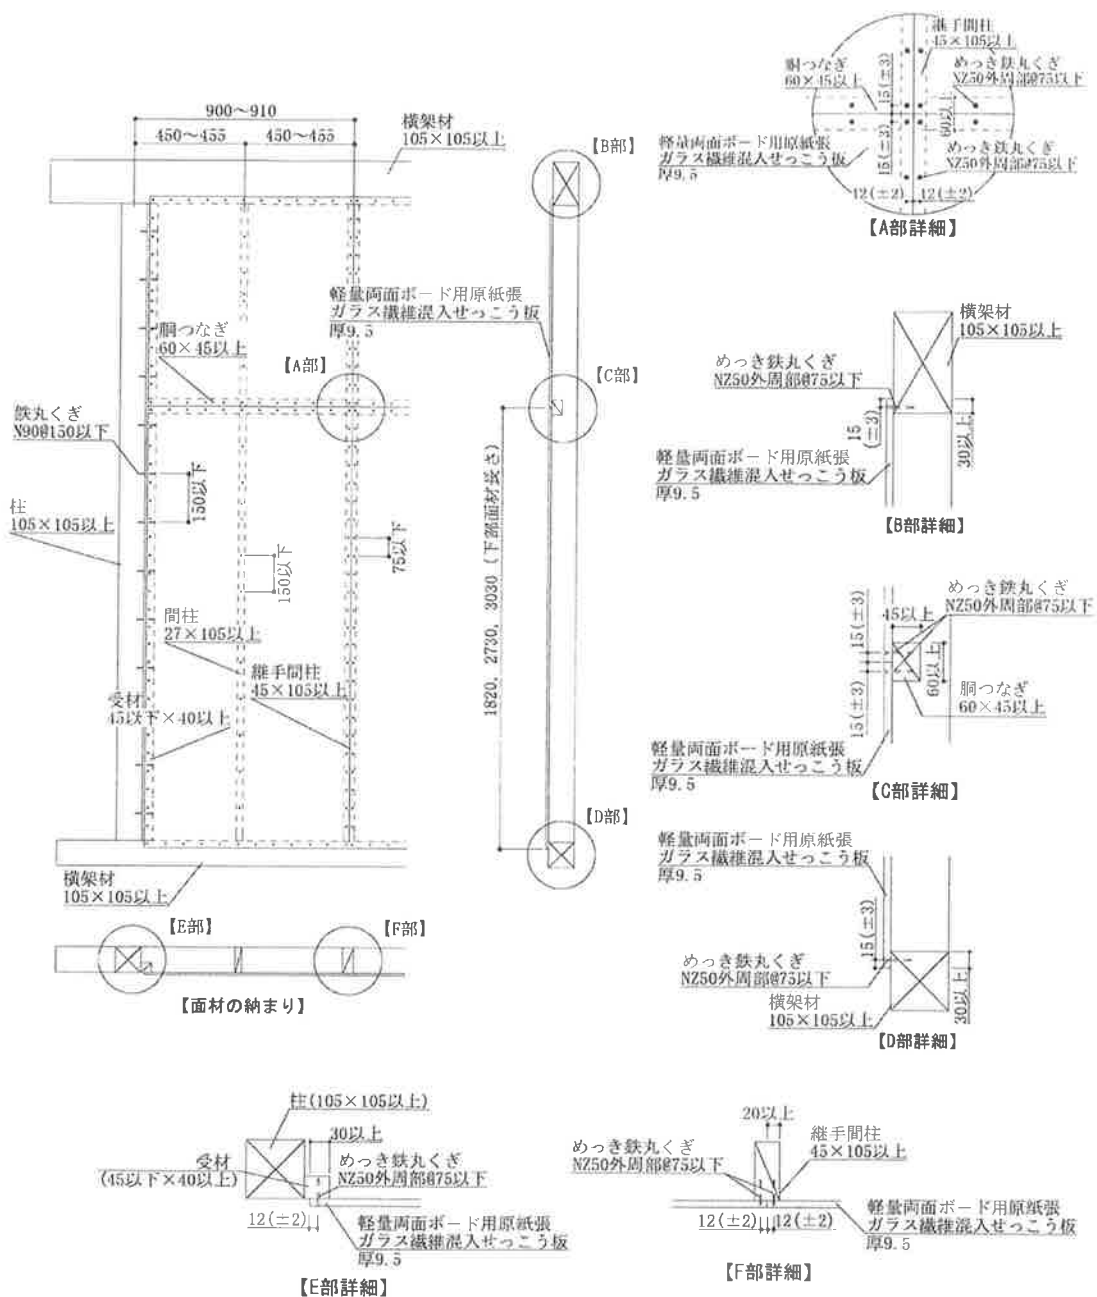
施工図：縦継ぎ張りの場合 (寸法単位：mm)
